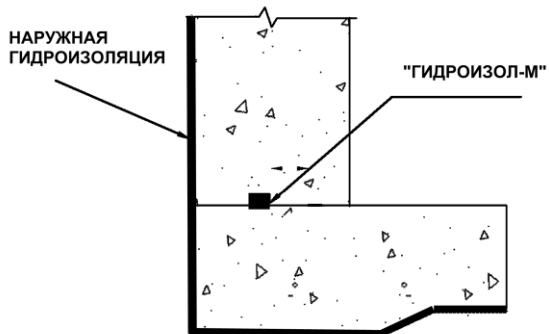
Монтаж шнура без нижней горизонтальной гидроизоляции свайного оголовка и плит.
